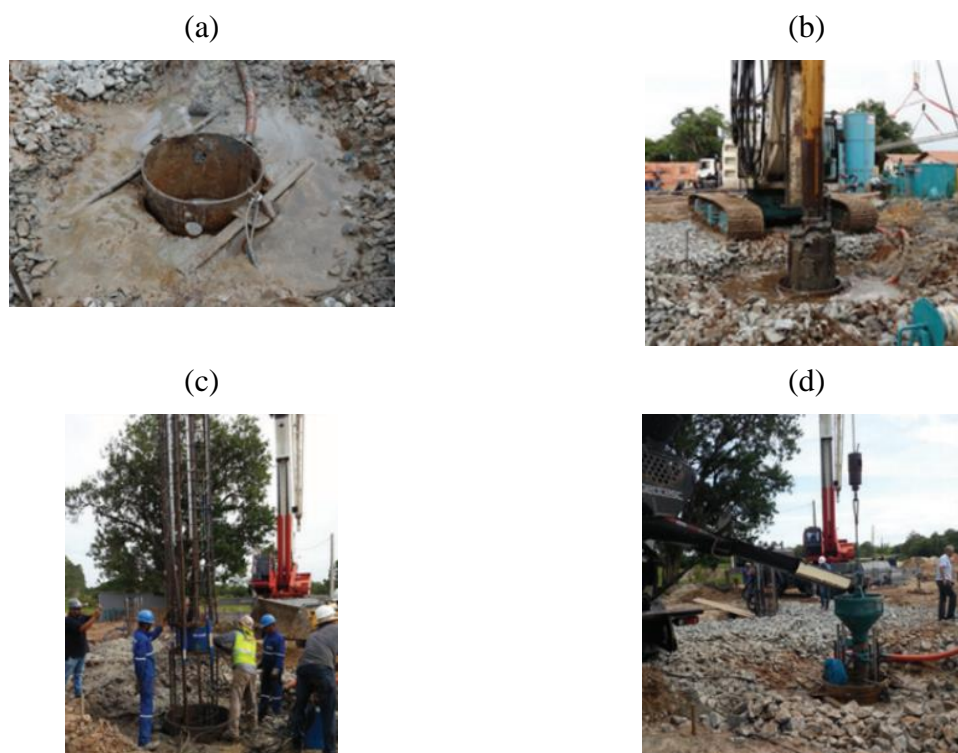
Procedimento executivo da estaca ET02: (a) posicionamento da camisa metálica; (b) escavação; (c) posicionamento da armadura; e (d) concretagem (PEREIRA, 2016).
